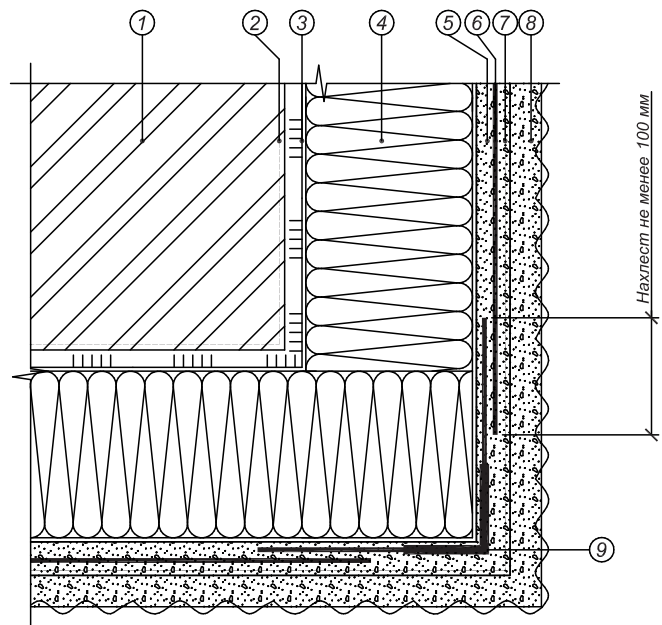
Схема установки элементов и армующей сетки на кутах будівлі з кутиком з сіткою
